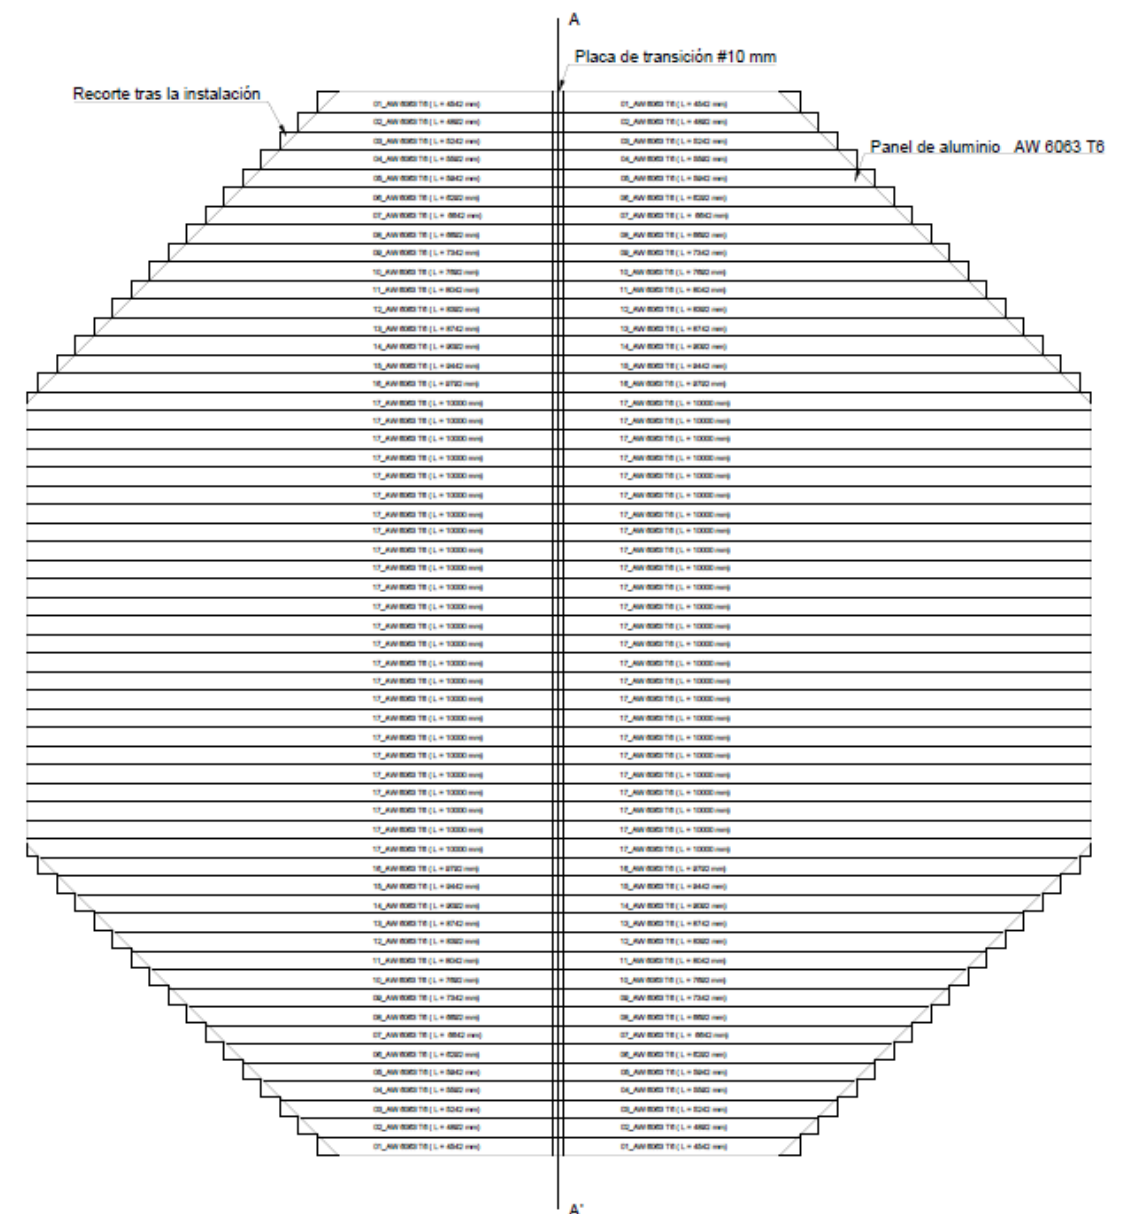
Montaje de los paneles de aluminio. Fuente: Propia.
